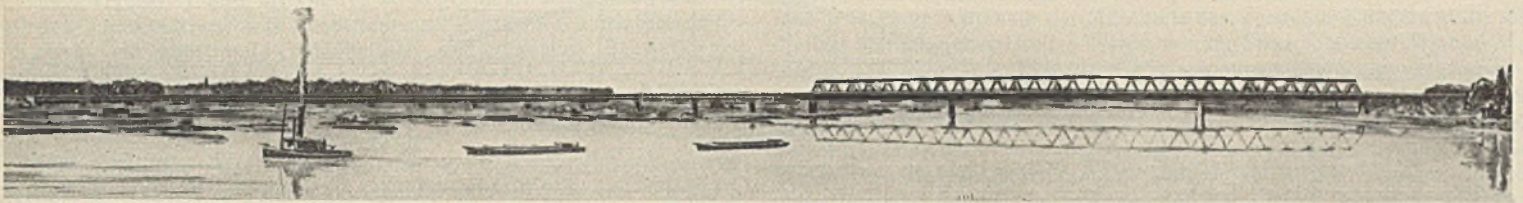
Schaubild eines Fachwerkbrückenentwurfs.
